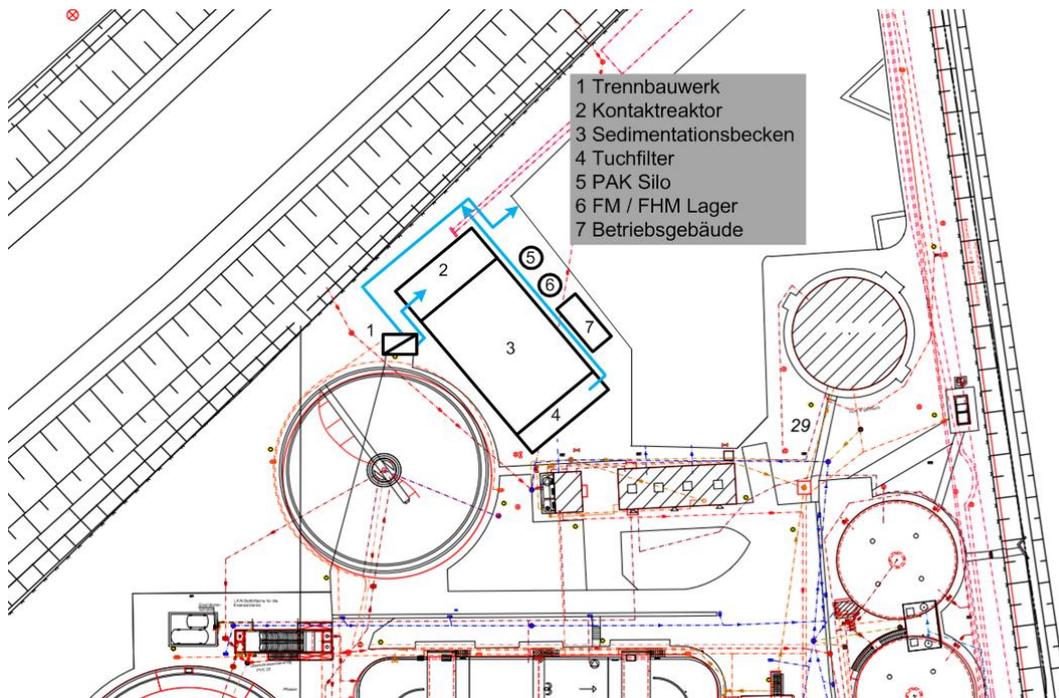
Lageplan PAK-Anlage auf der Münster-Geist
